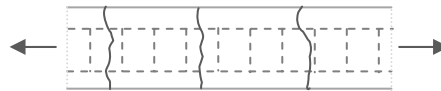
Esquema de fissura: fissura de tracció.
